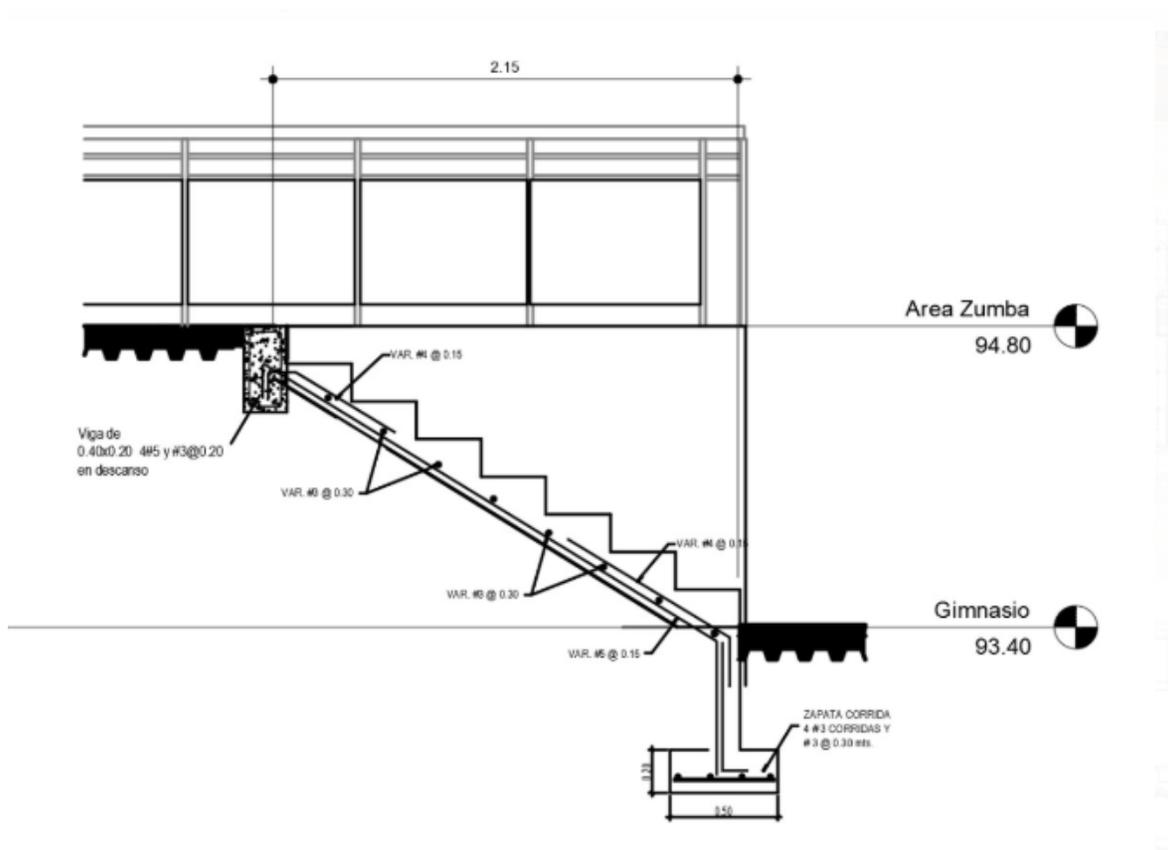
Detalle Estructural Escales proyecto DAVIVIENDA
